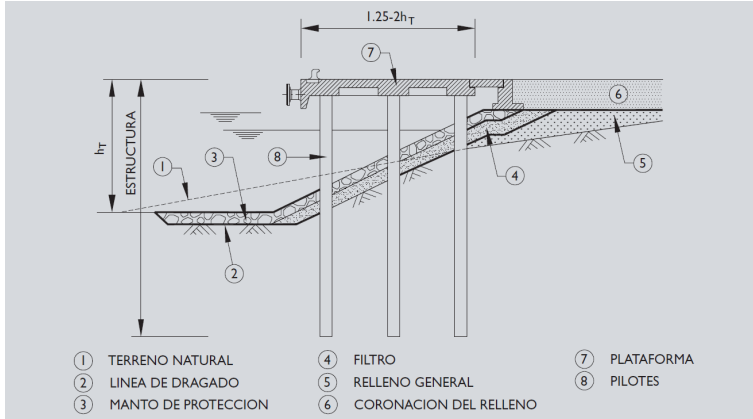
Sección tipo de un muelle de pilotes. Adaptado con permiso de ref. [41]. Copyright, 2011, Puertos del Estado.
